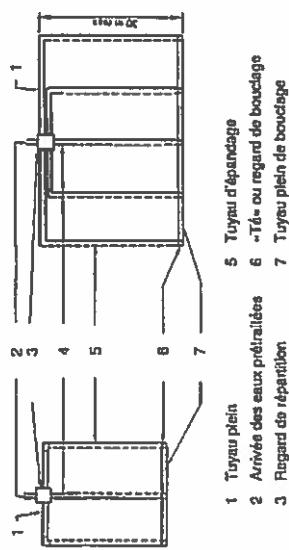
Vues en plan ; exemples à 3 et 5 tranchées
